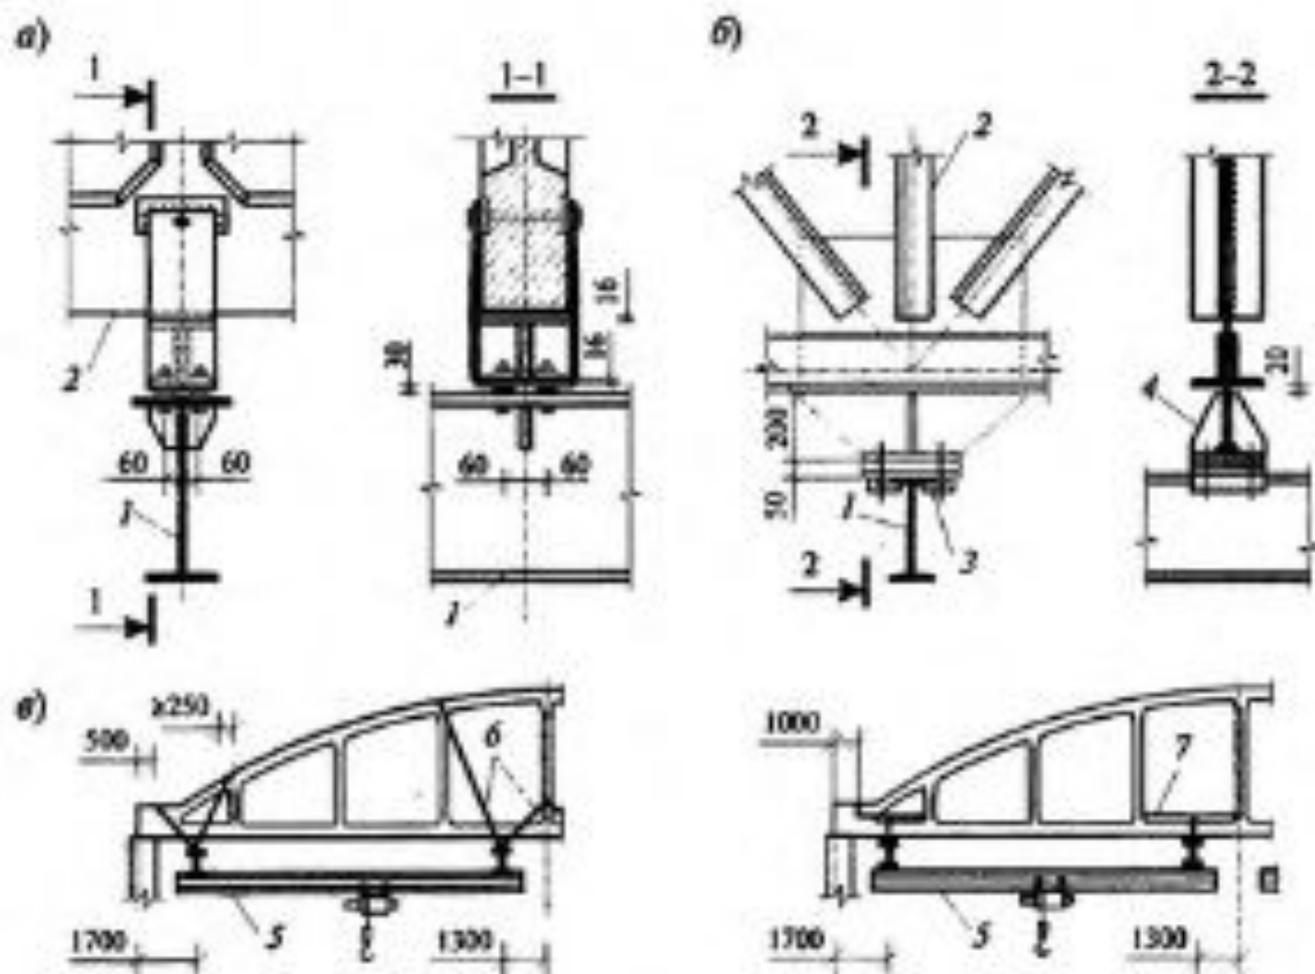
Способы крепления подвесных путей к стропильным конструкциям:
